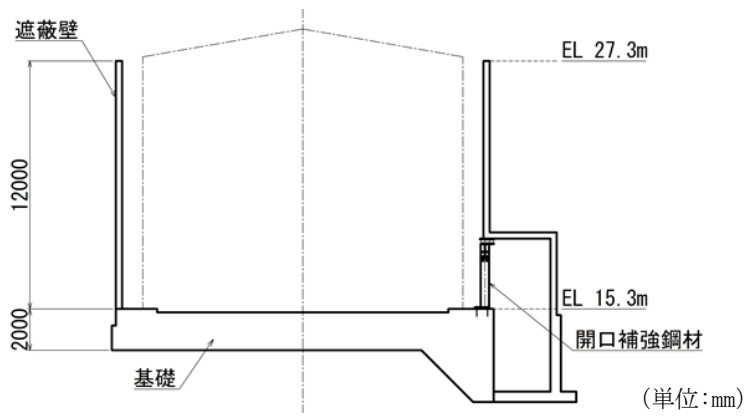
トーラス水受入タンク遮蔽壁 断面図 (A-A断面)
